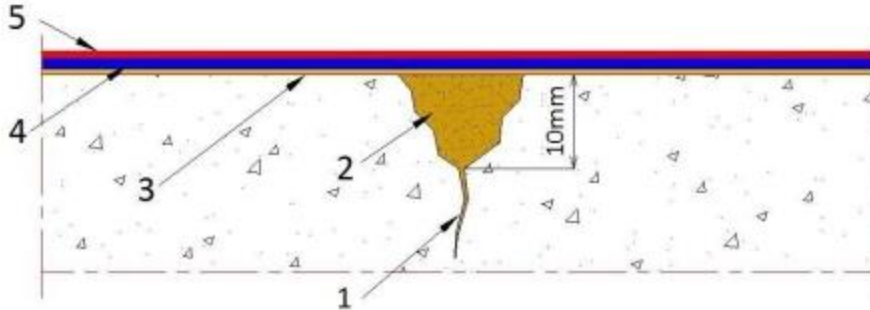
Traitement des fissures entre 0,3 et 2 mm
